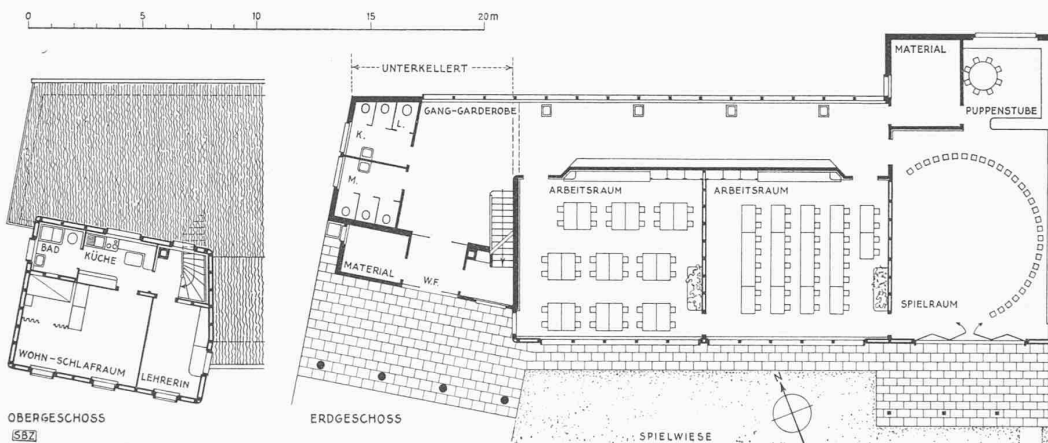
Grundrisse vom Erdgeschoss und Obergeschoss
